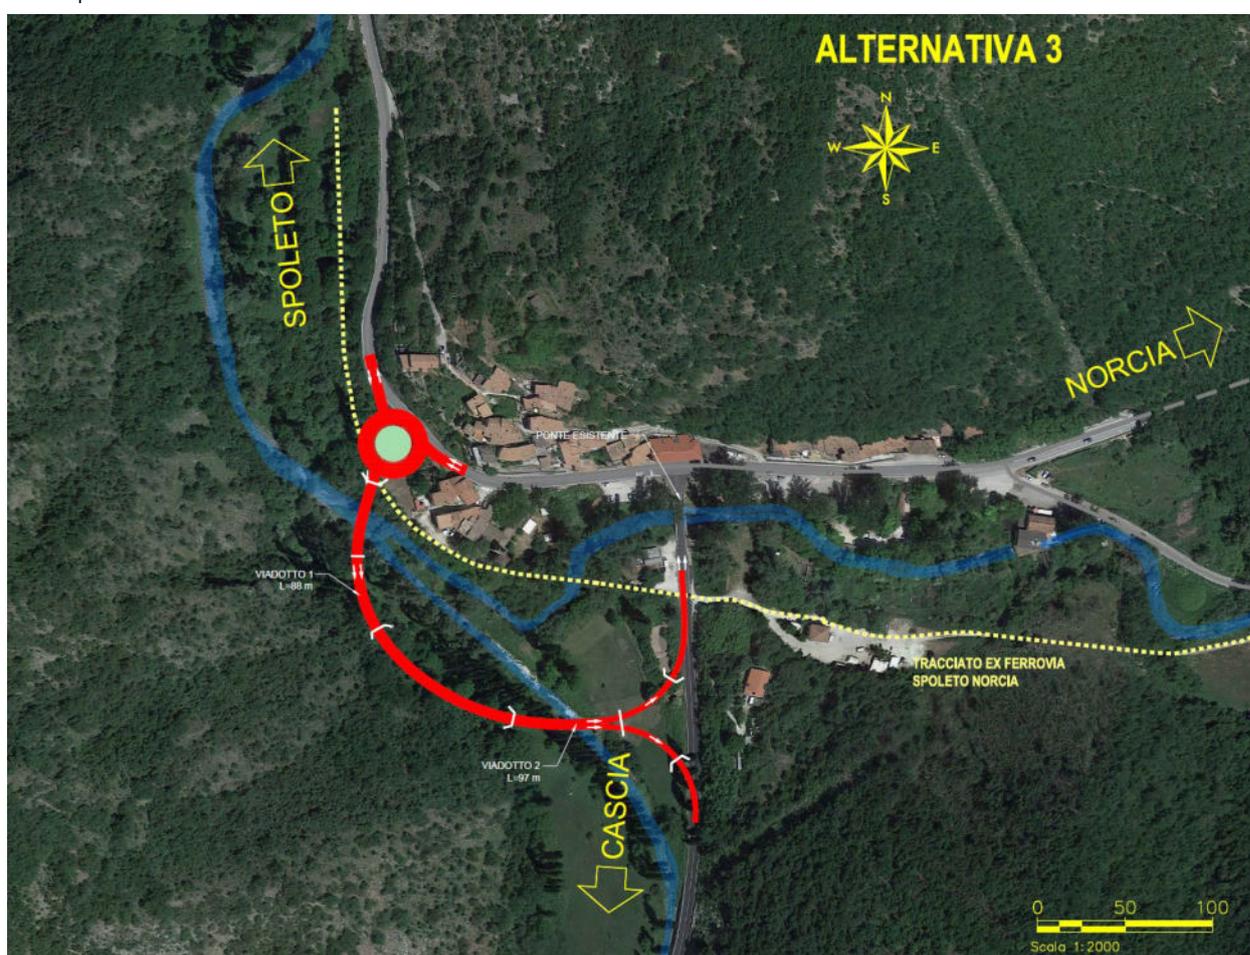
Planimetria di progetto Alternativa3- anello rotatorio
